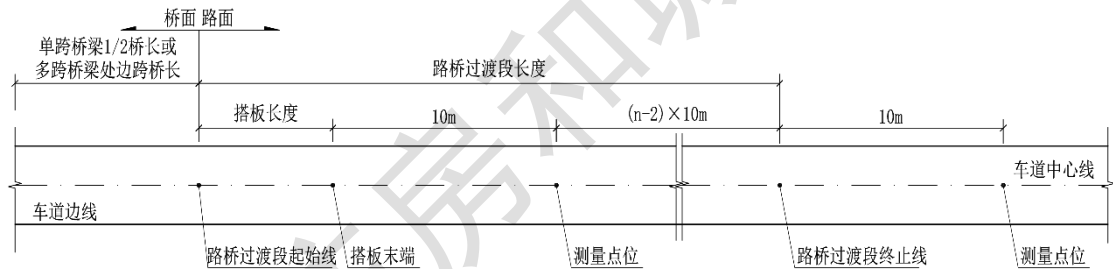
桥头设搭板时纵坡测量平面示意图
